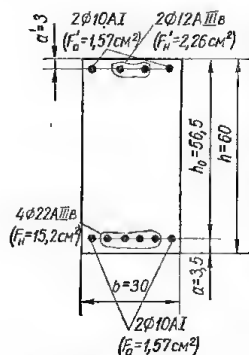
Схема сечения предварительно напряженной железобетонной балки.
